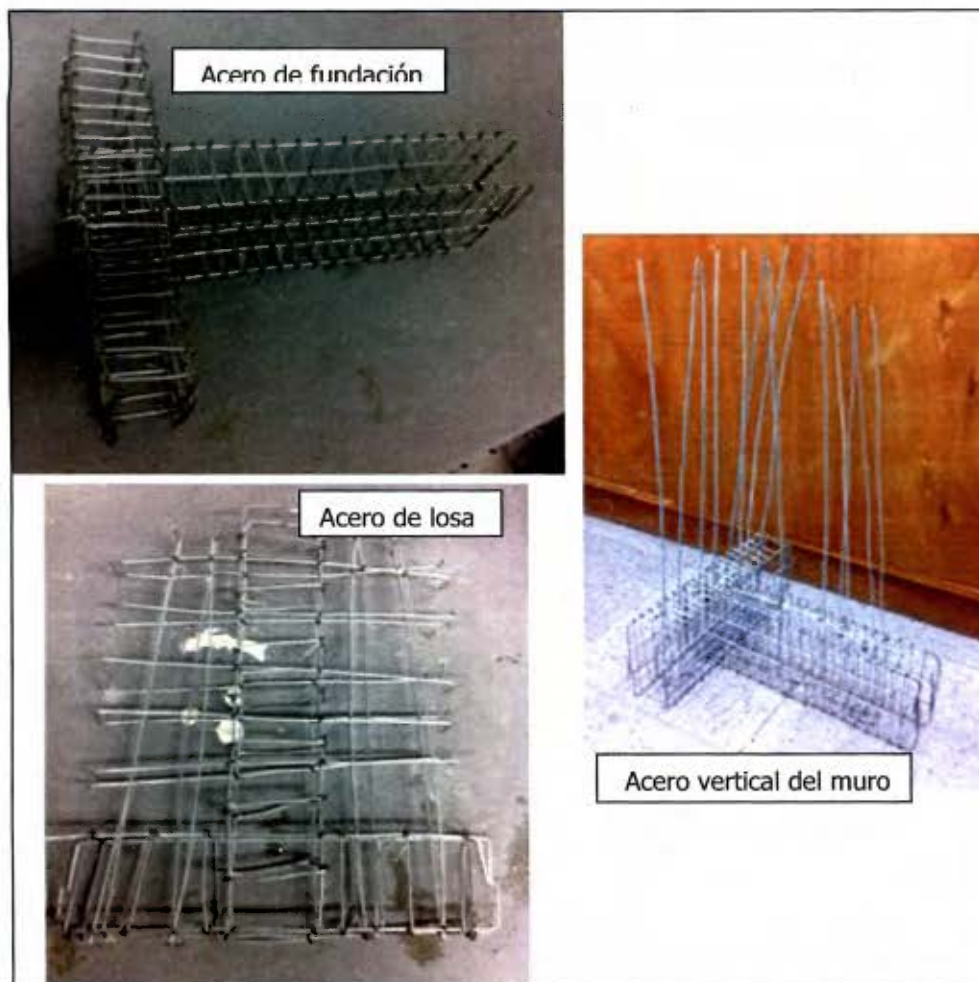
Armaduras de la fundación y de la losa y colocación del acero vertical.
